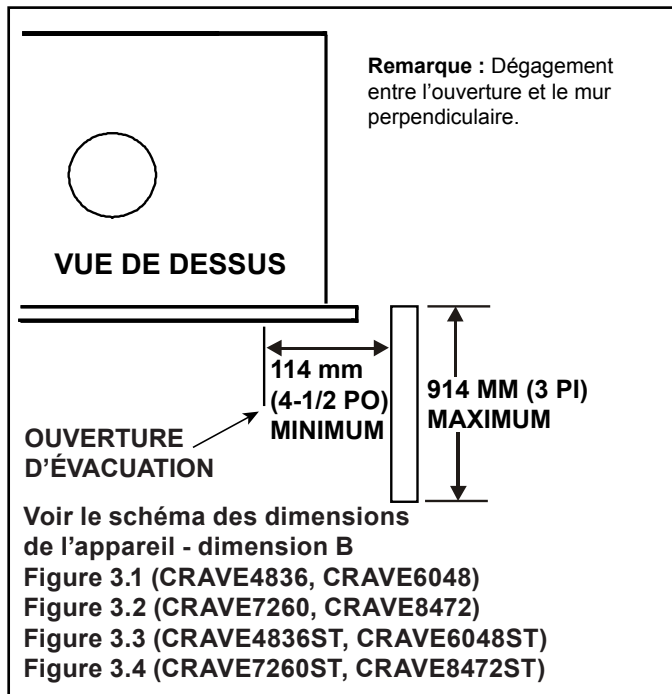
Pied du manteau de foyer ou saillies du mur
